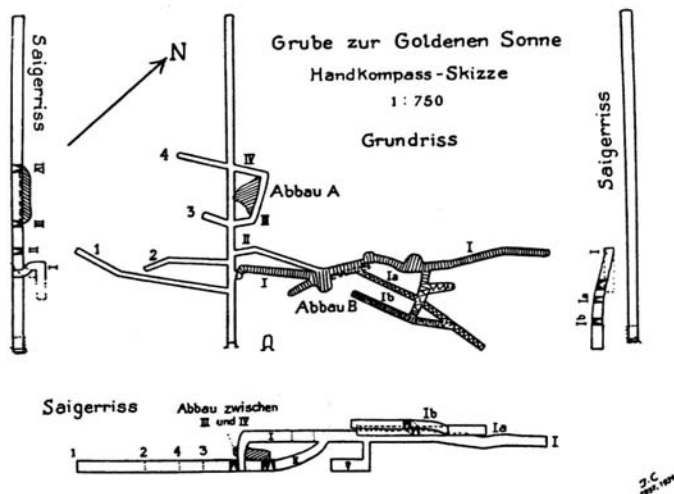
Grubenplan mit Saigerrissen Grube Fliden,
